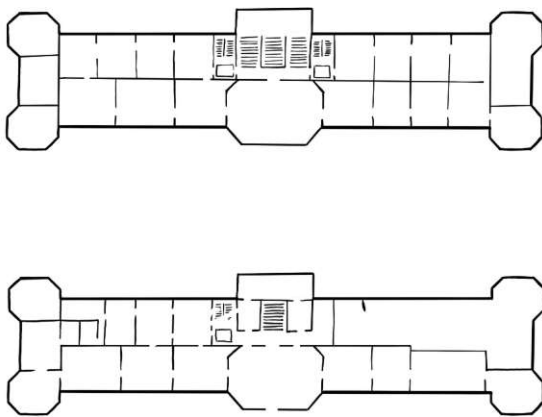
| Grundrisse EG & OG Oberes Belvedere
